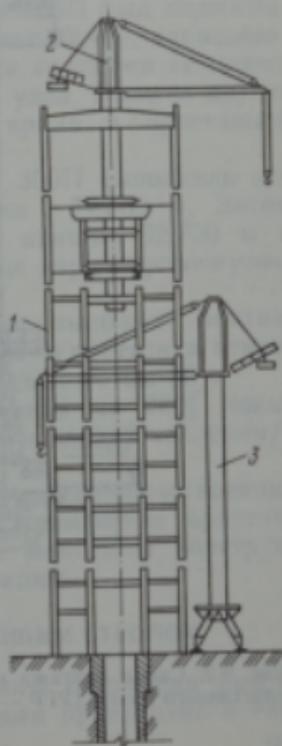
Монтаж башенного копра над неработающим стволом:
